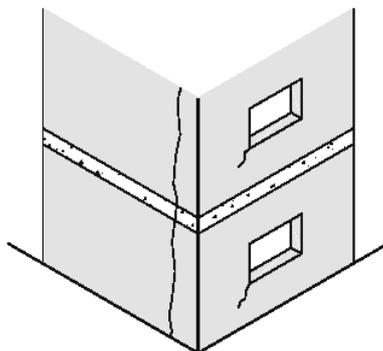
Fissuração vertical da alvenaria no cunhal da obra provocada por movimentações higroscópicas
